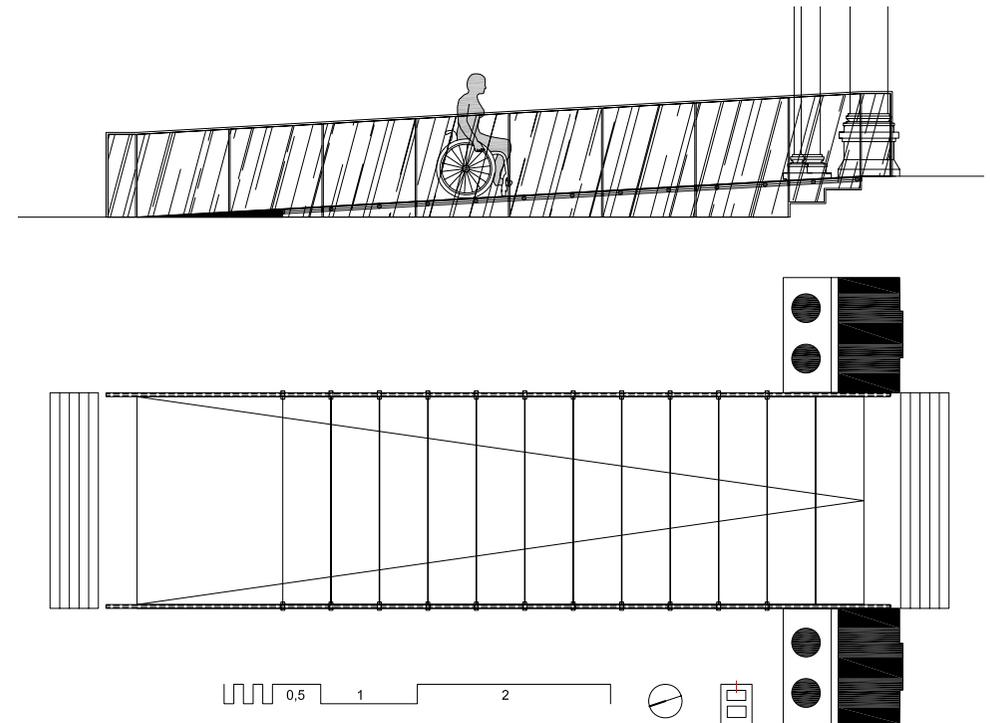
Grundriss und Schnitt durch die Glasrampe im Foyer
